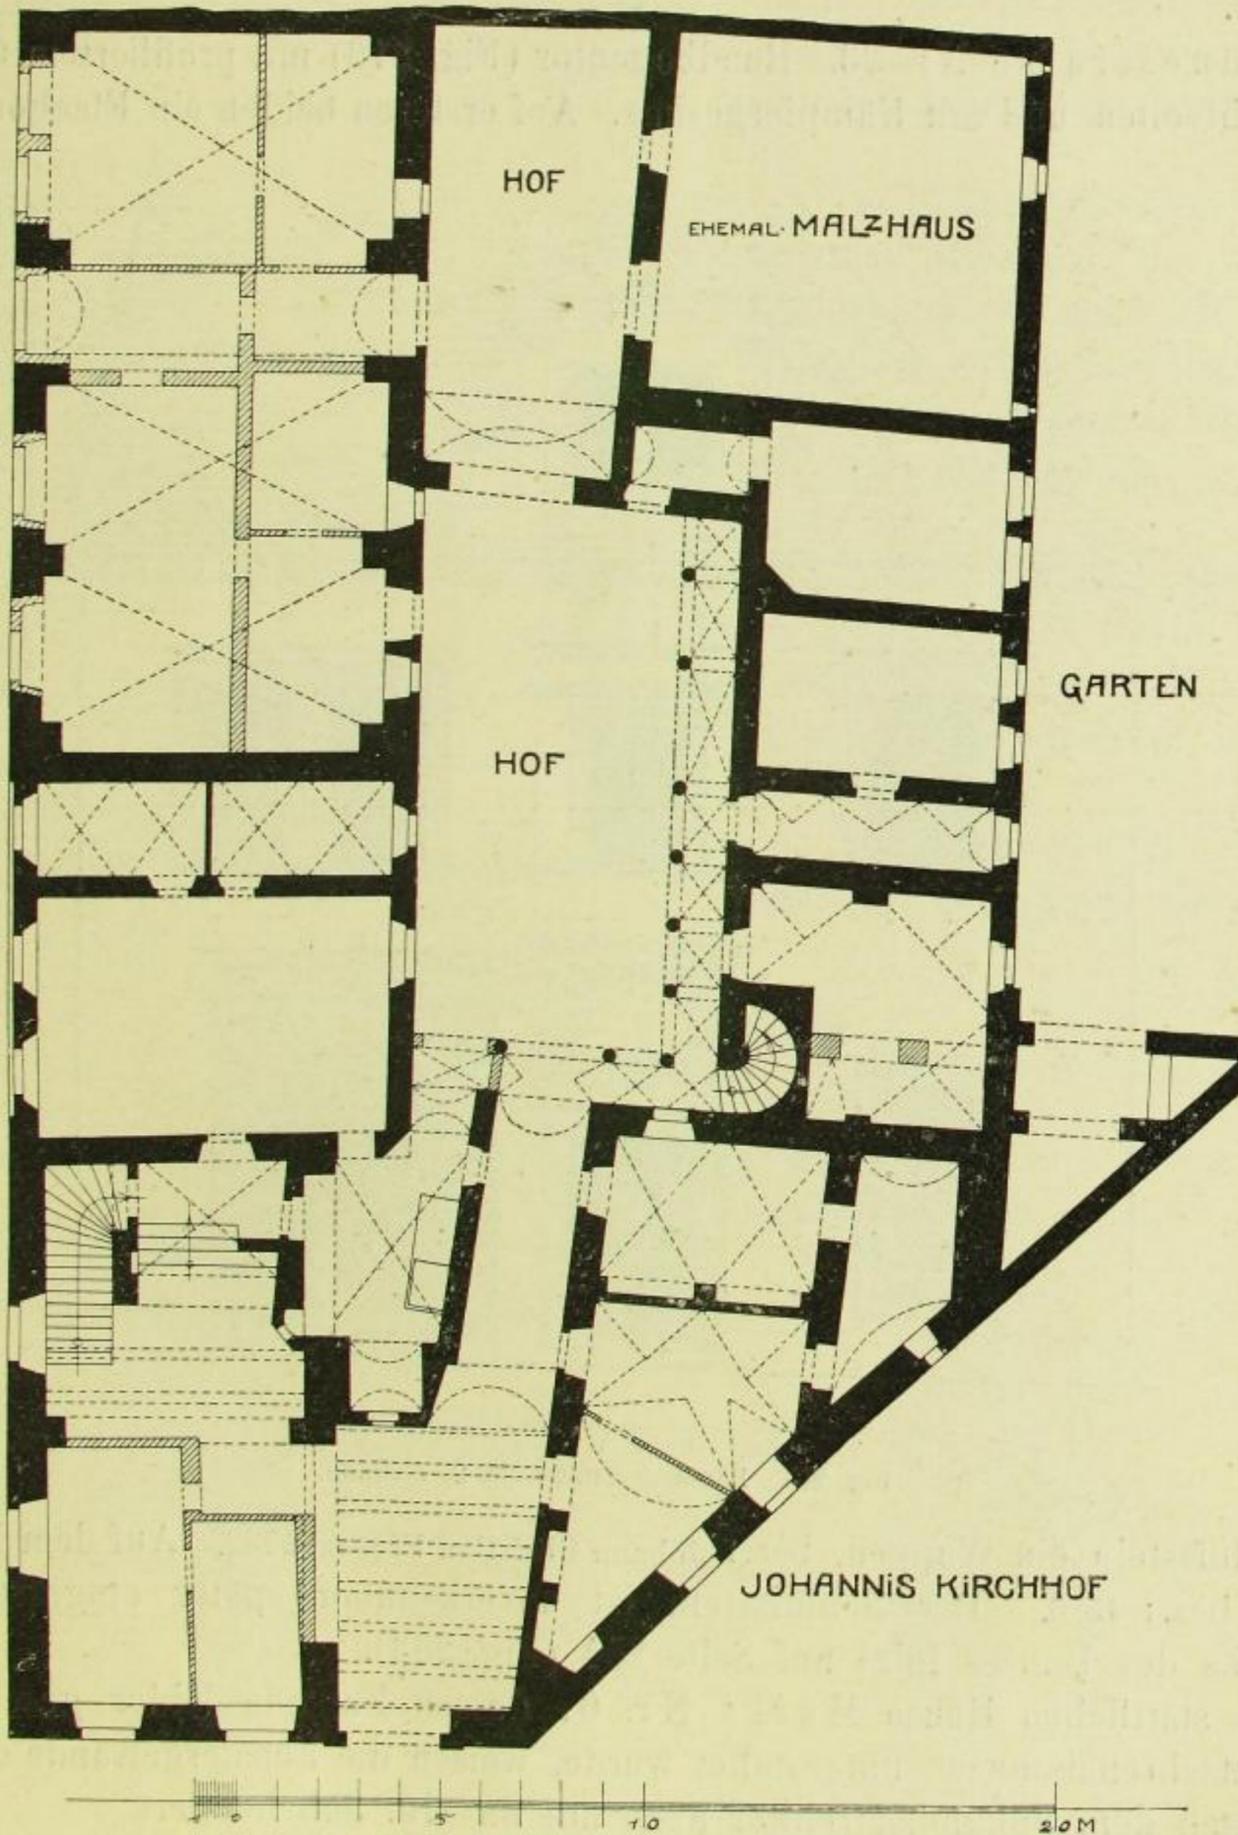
Bautzner Straße Nr. 2, Grundriß.
